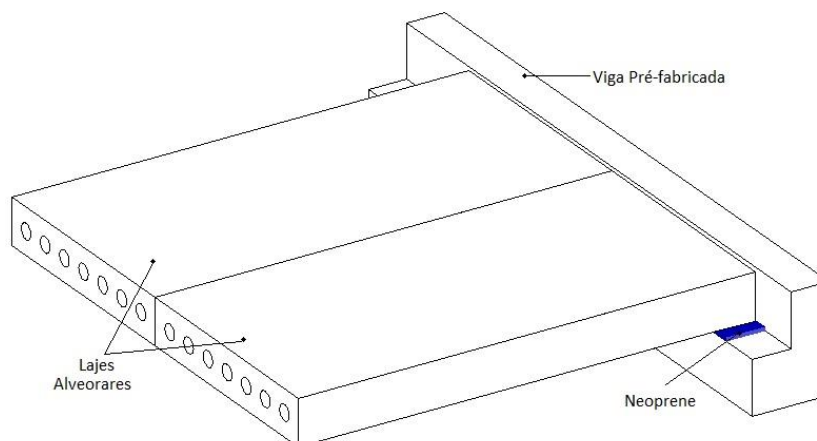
Ligação Laje – Viga de extremidade simplesmente apoiada
